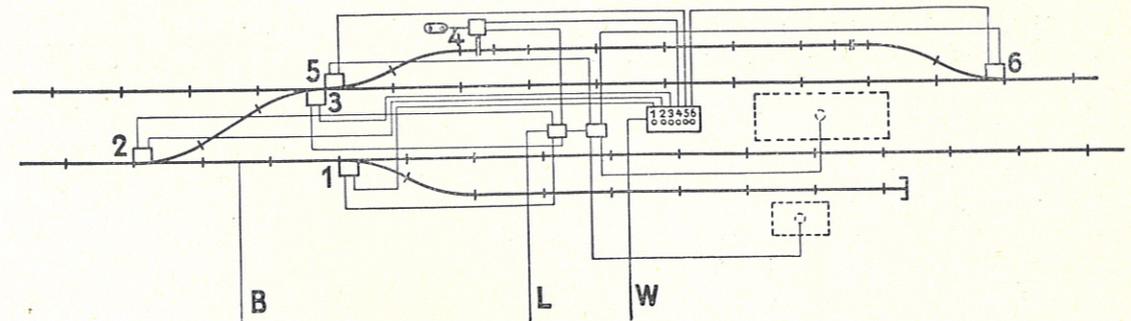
Schaltungsplan einer Durchgangsbahnhofsanlage
